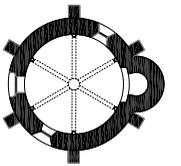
Grundriss BDA Wien. M 1:400.
